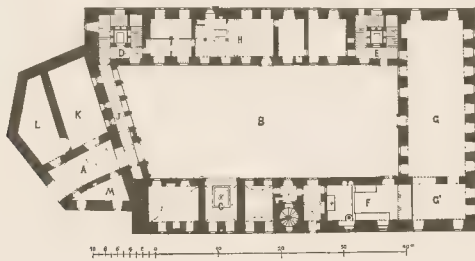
Grundriss des Schlosses Heiligenberg. Nach Luecke
